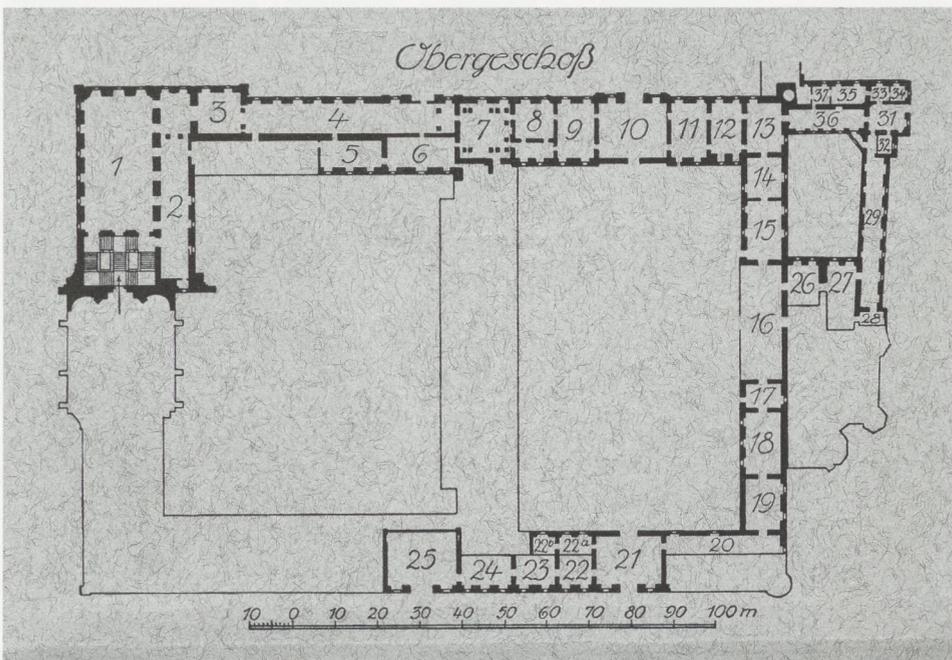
Berliner Schloss, Grundriss des zweiten Obergeschosses des Schlossmuseums mit Raum 3 als Ausstellungsraum für den »Pommerschen Kunstschrank«, aus: Kat. Slg. Berlin 1927
